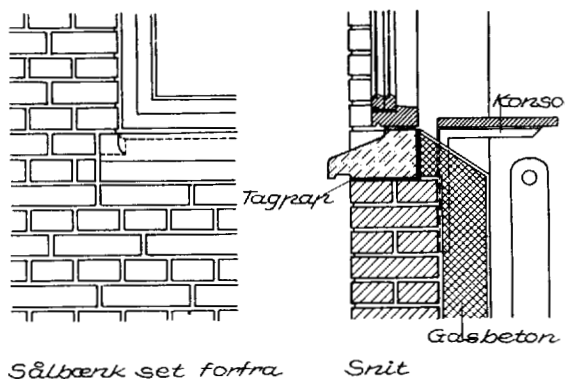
Betonsålbænk, ført et stykke ind i muren.
